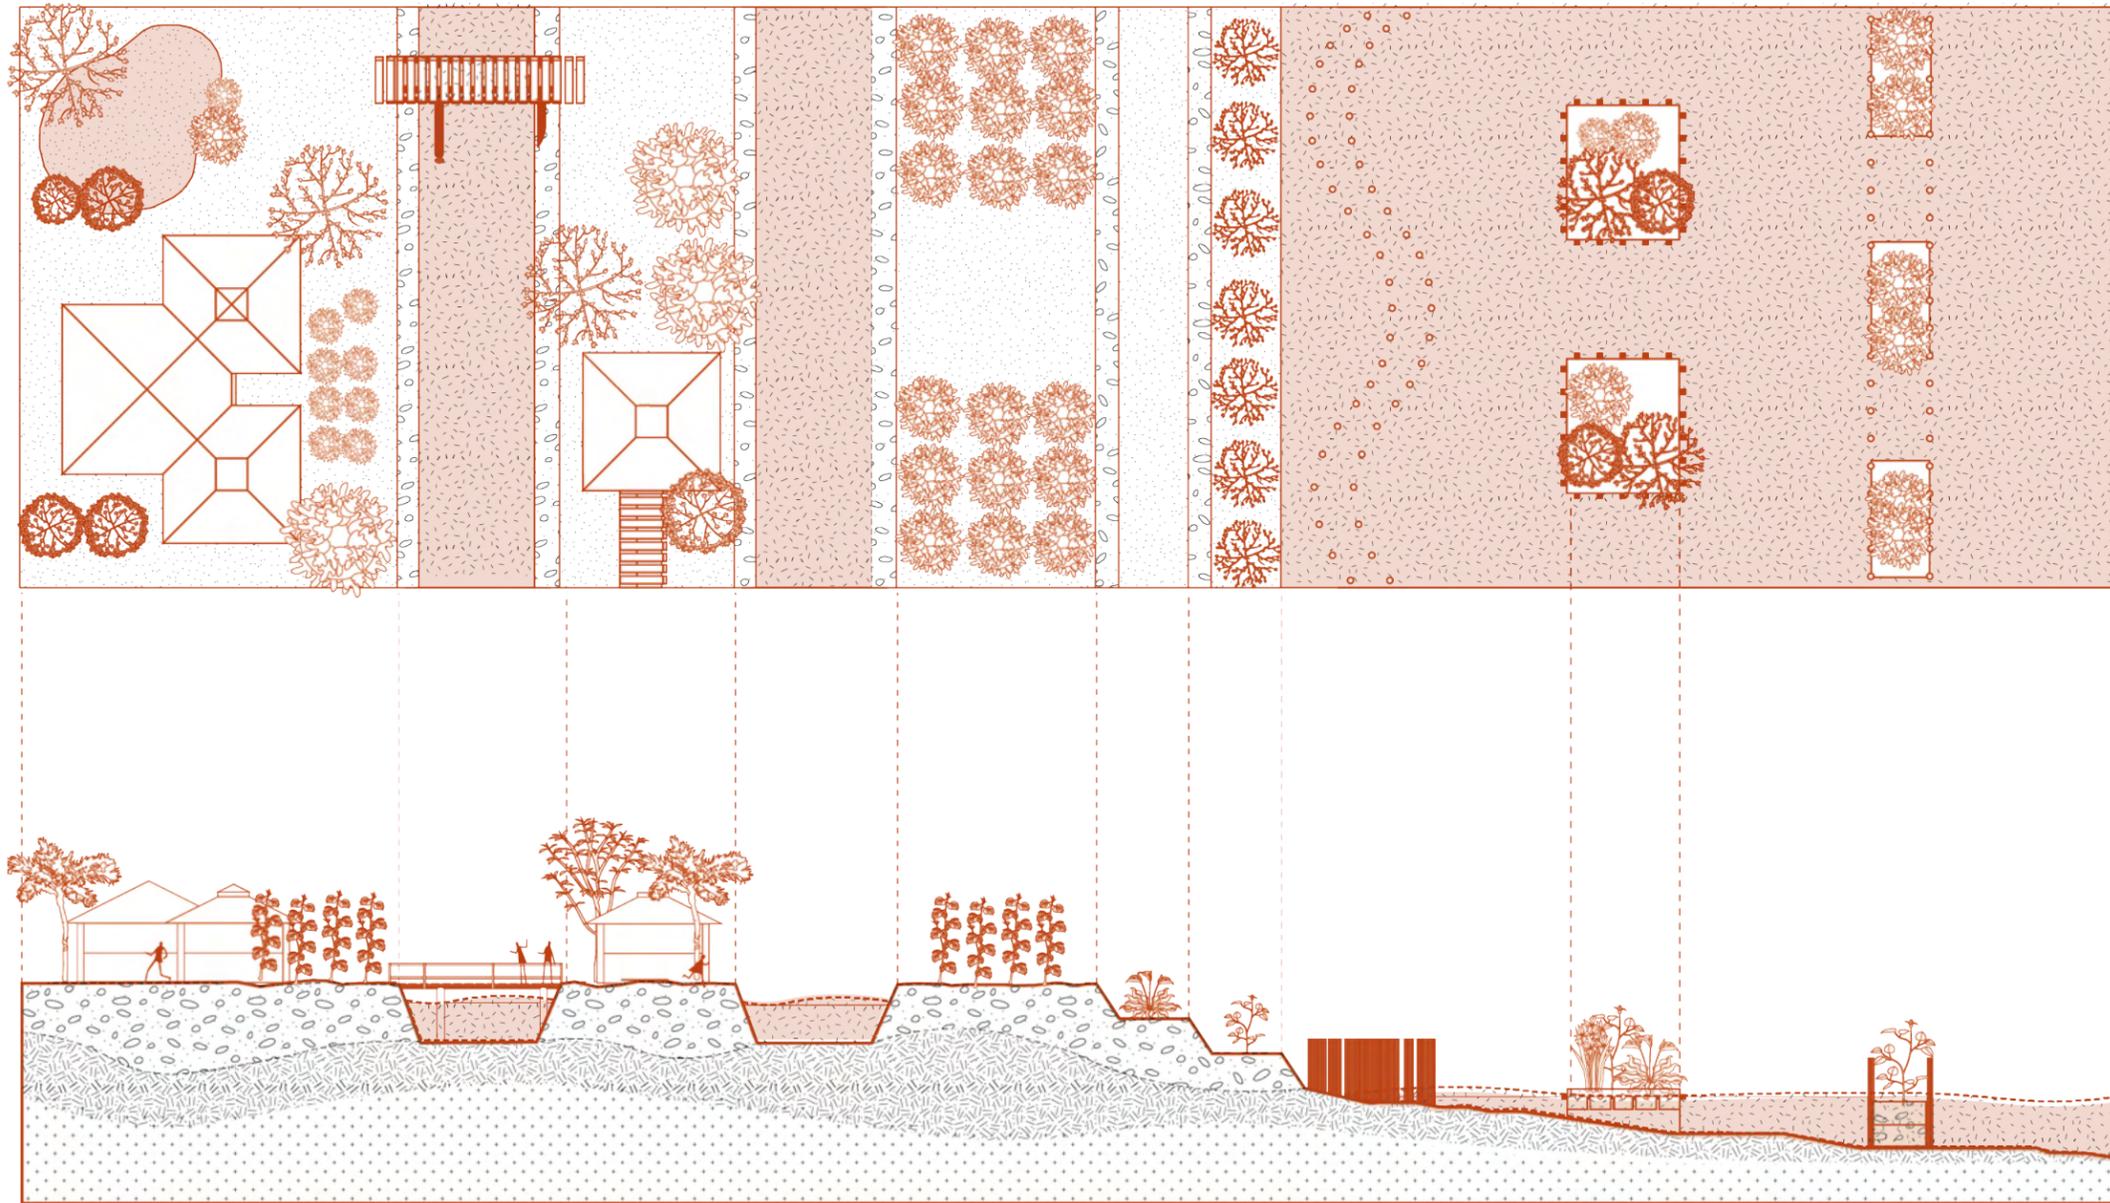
Planta y sección de la propuesta. Elaboración propia.
